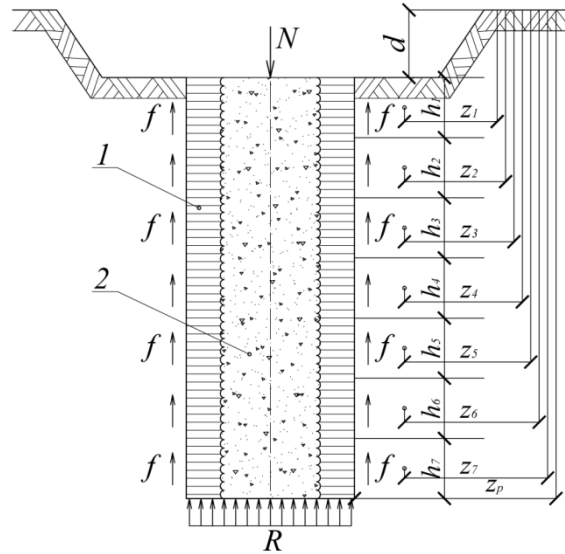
Схема к определению несущей способности сваи SFA (НПШ) совместно с грунтоцементным массивом по грунту (грунтобетонные сваи (ГБС): 1 – грунтоцементный массив, 2 – свая SFA (НПШ)
